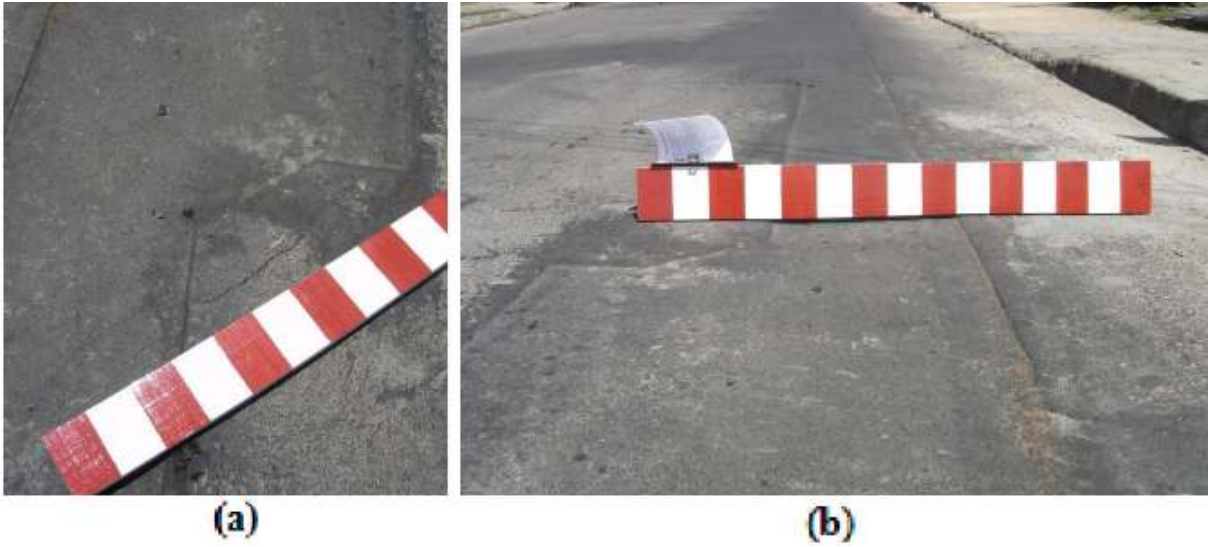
dano causado no pavimento (a) pelo afundamento da repavimentação (b)
